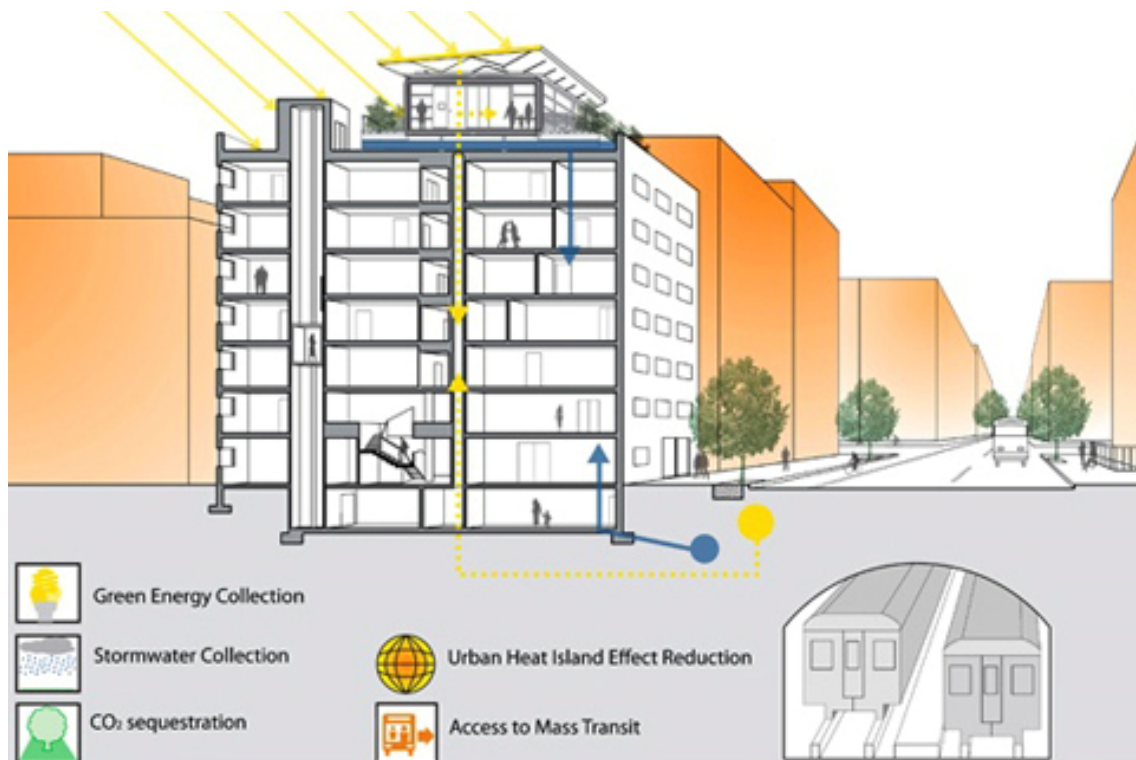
Proyectos RoofPod New York (fuente Team New York: The City College of New York 2011)
